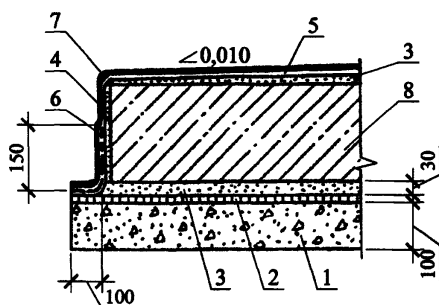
Узел 15. Литая и окрасочная гидроизоляция
